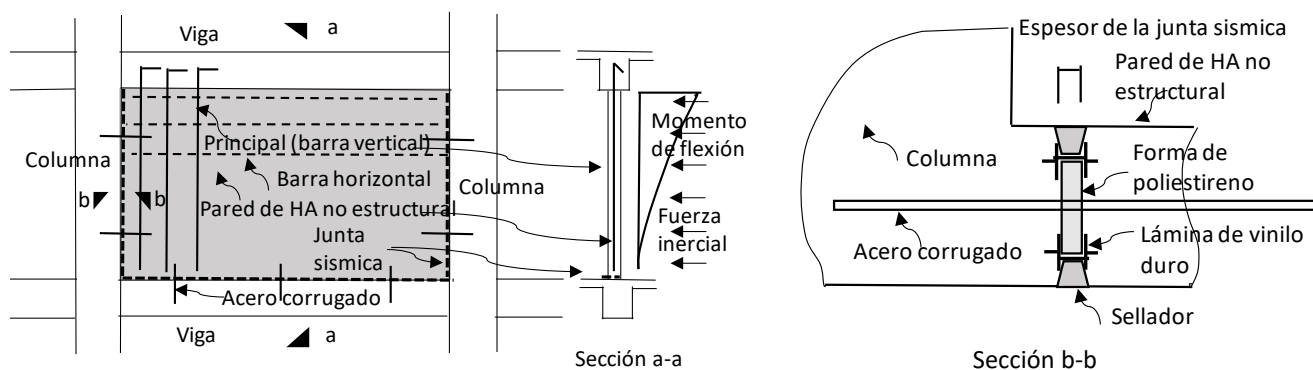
Junta sísmica y refuerzo para la pared de hormigón armado
